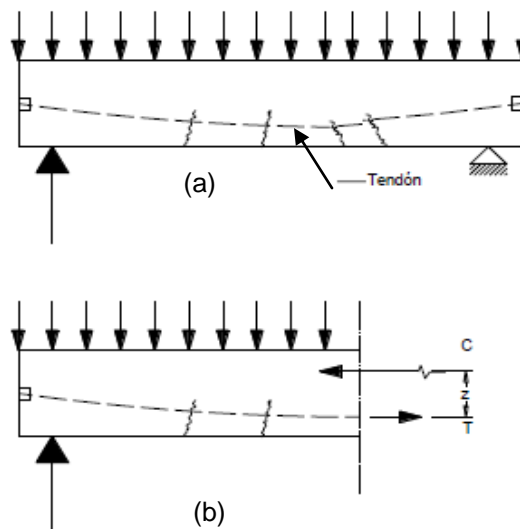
Viga de hormigón preesforzada sometida a una carga cercana a la que produciría la falla por flexión: (a) viga con la carga mayorada aplicada; (b) equilibrio de fuerzas en la mitad izquierda de la viga.
